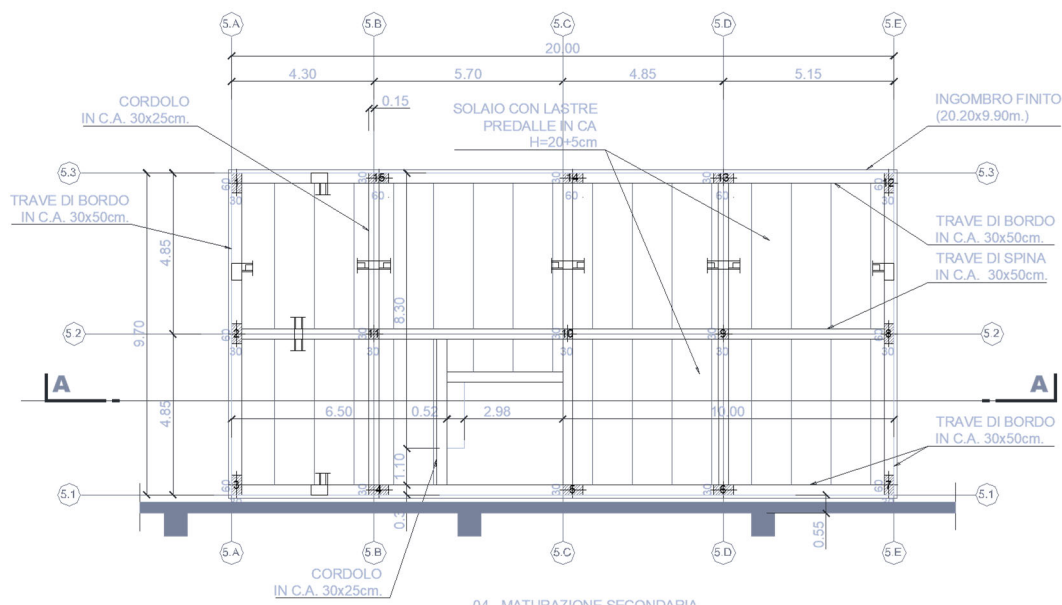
PIANTE SOLAIO DELLA PALAZZINA UFFICI
